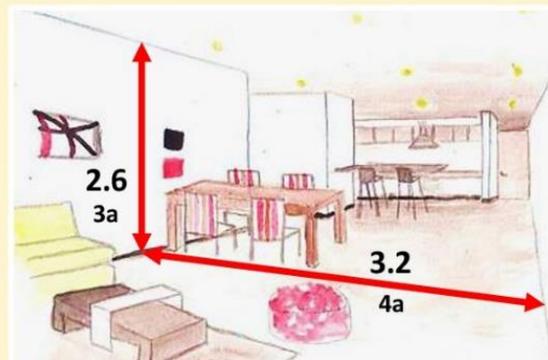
Vista interior de la sala de un departamento Fuente: propia
